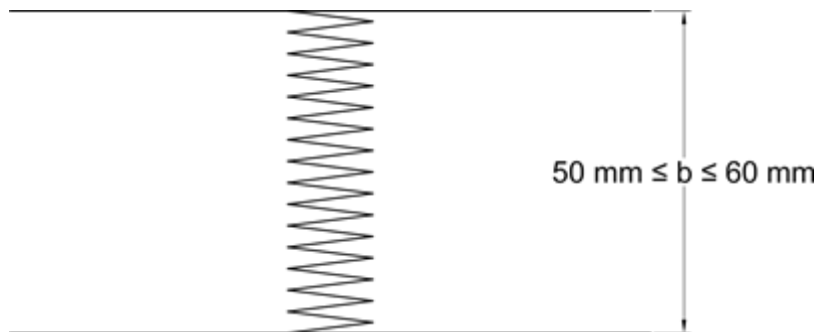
Draufsicht auf das keilgezinkte Holz
